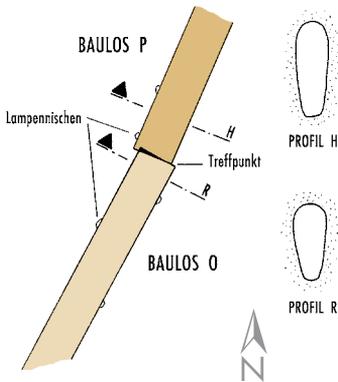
Detail: Treffpunkt Baulos O und P. M. 1:100.
